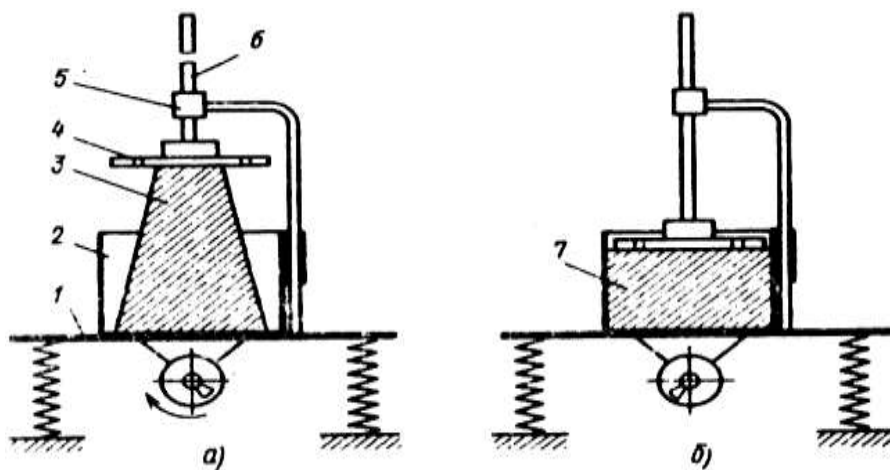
Определение жесткости бетонной смеси: а – прибор в начальном положении; б – то же в момент окончания испытаний; 1 – виброплощадка; 2 – цилиндрическая форма; 3 – бетонная смесь; 4 – диск с отверстиями; 5 – втулка; 6 – штанга; 7 – бетонная смесь после вибрирования
